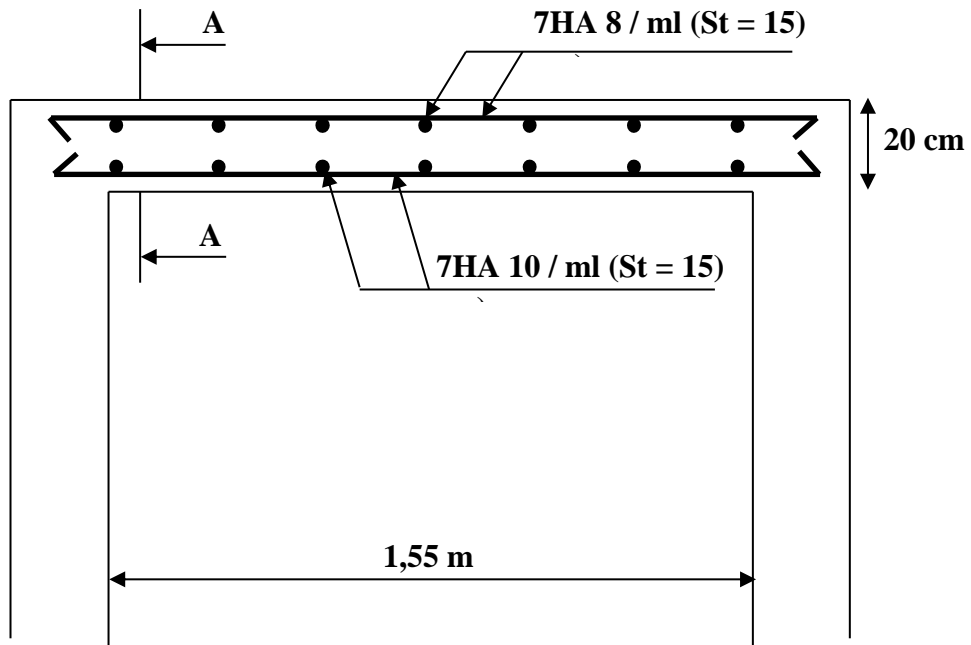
Plan de ferrailage dans le sens (x-x)
